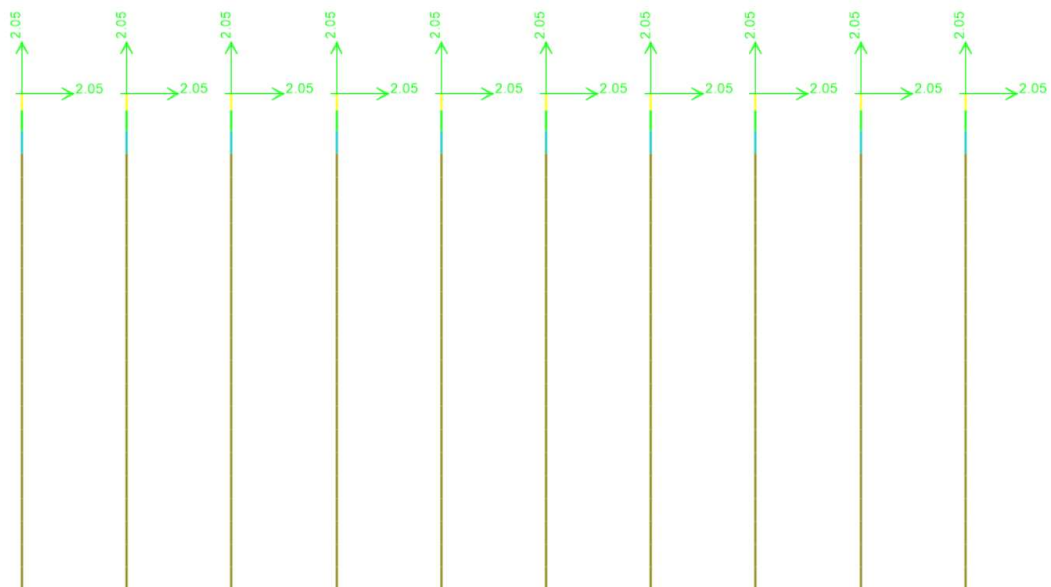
Joint Masses de pilotes verticales - Eje H (2.05 kN-s²/m)
